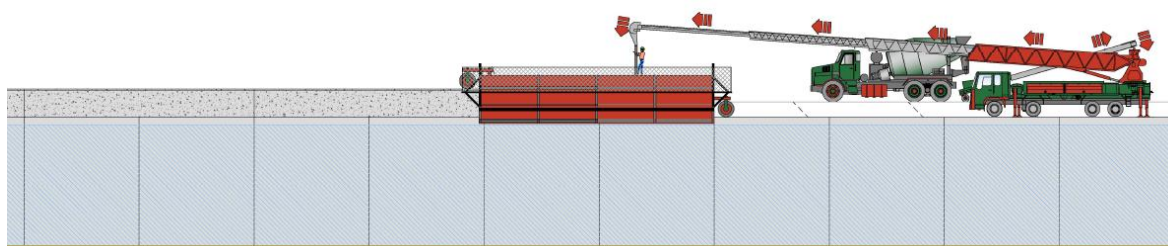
Desenho esquemático – execução da superestrutura com cofragem deslizante
